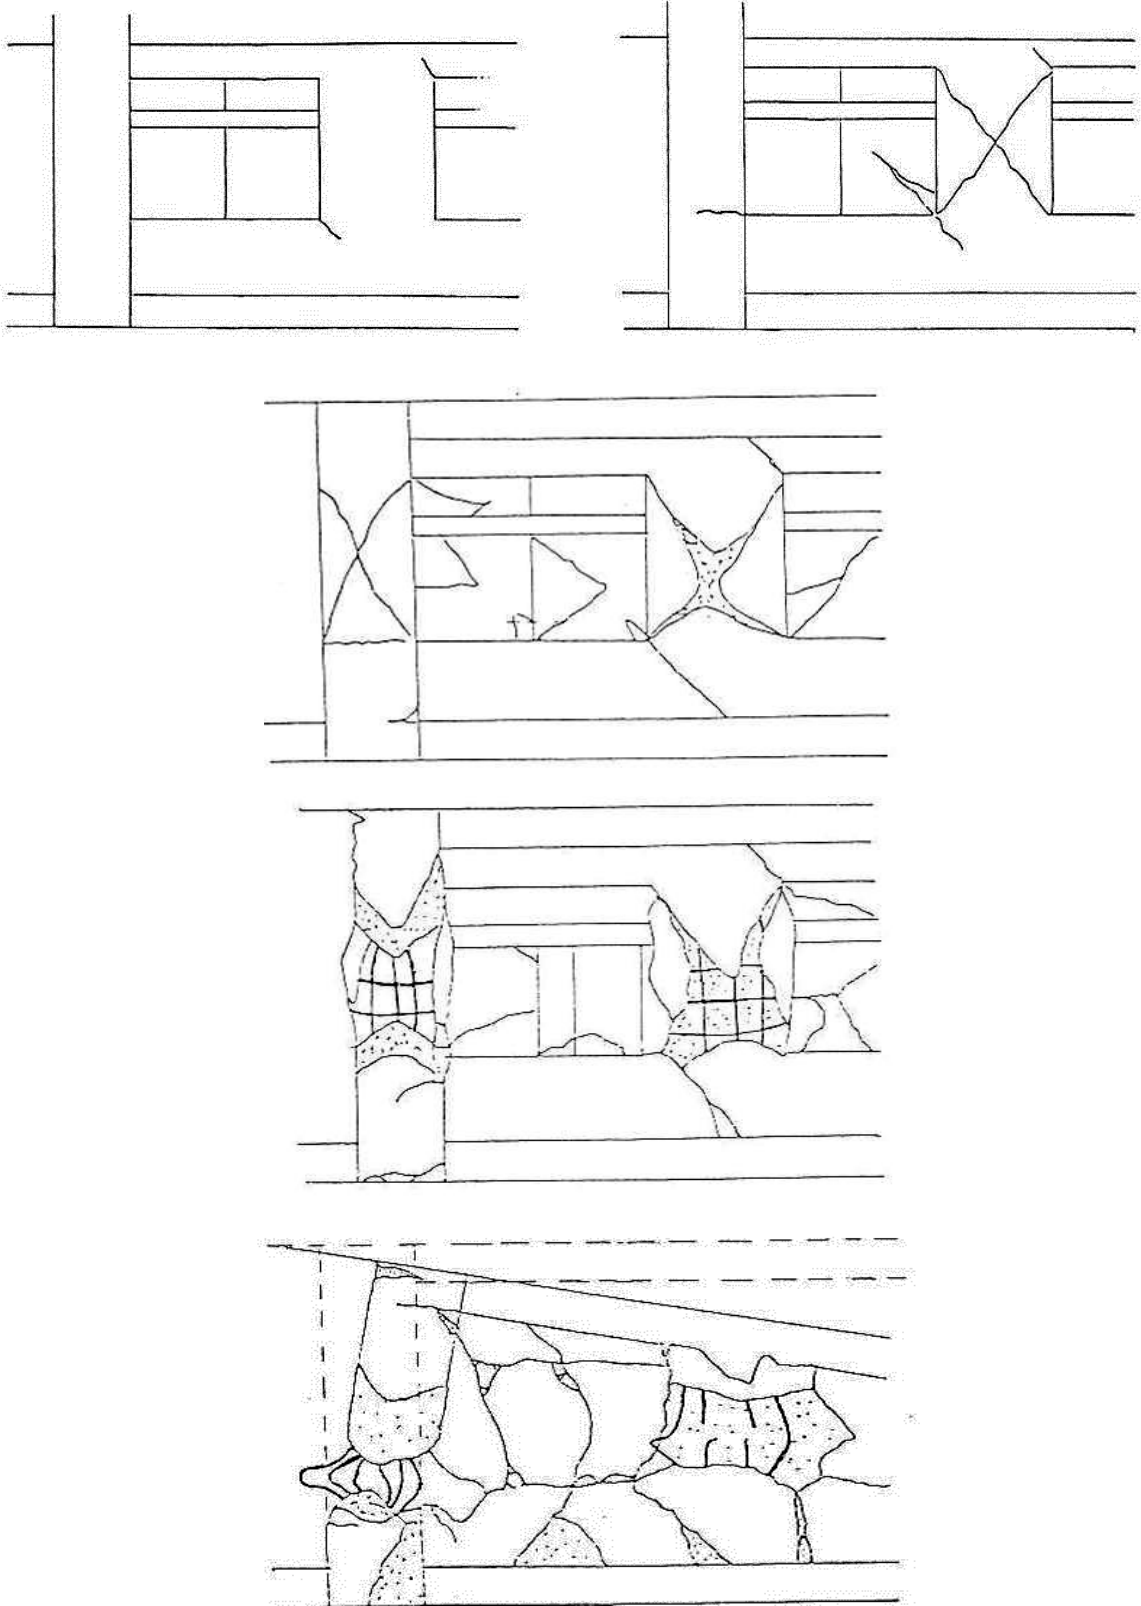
Kolonlarda Mafsallaşma Hasarı (III- kabuk betonunun dökülmesi, etriyelerin açılması, çekirdek betonunda çatlaklar)
